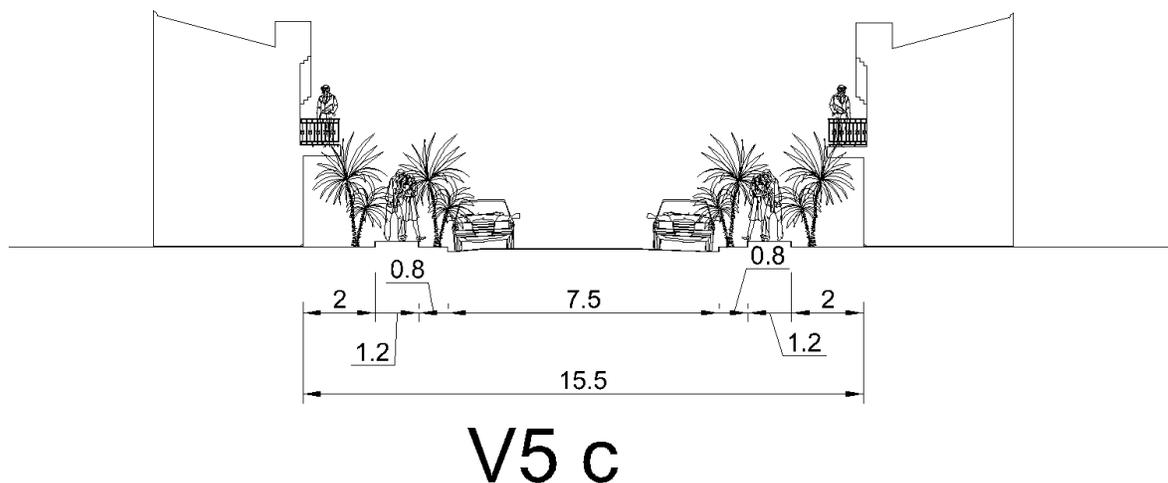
Perfil vial V5 c. Fuente: P.O.T plano U 13
